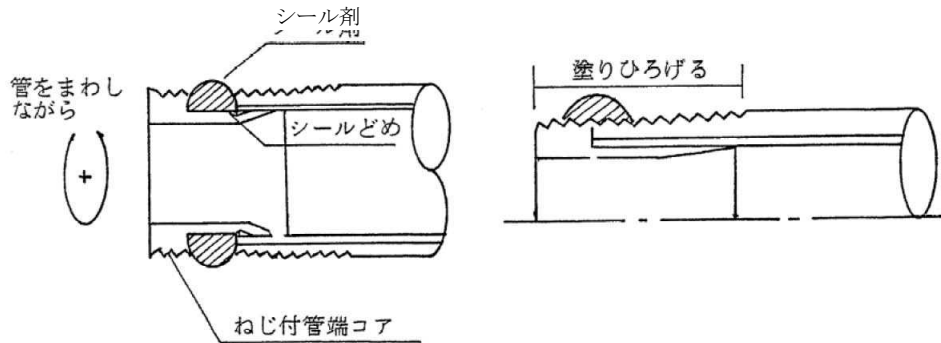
防食コアの施工 (ポリエチレン粉体ライニング鋼管)
